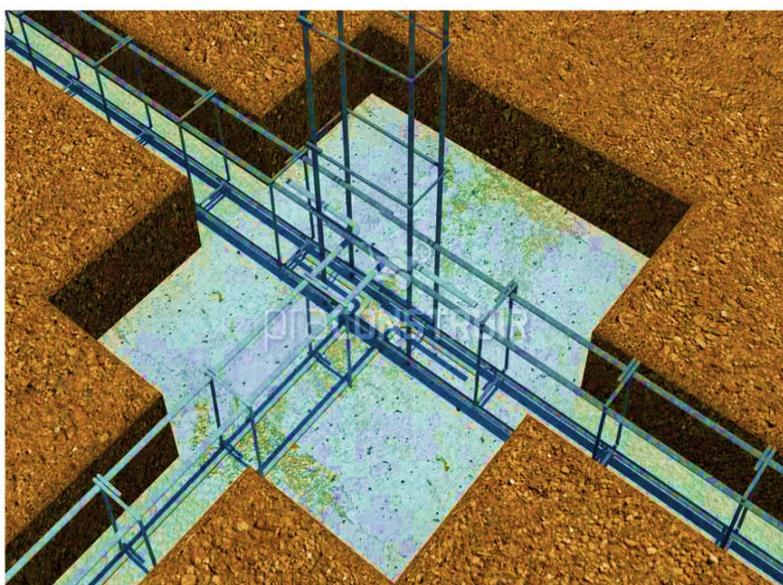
Vigas baldrame de uma casa; Fonte: Ciola, 2012
